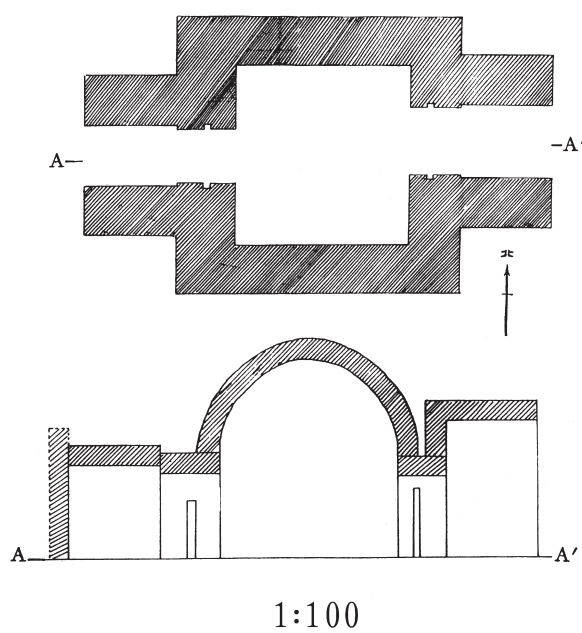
山东省东阿鱼山曹魏墓平·断面图
